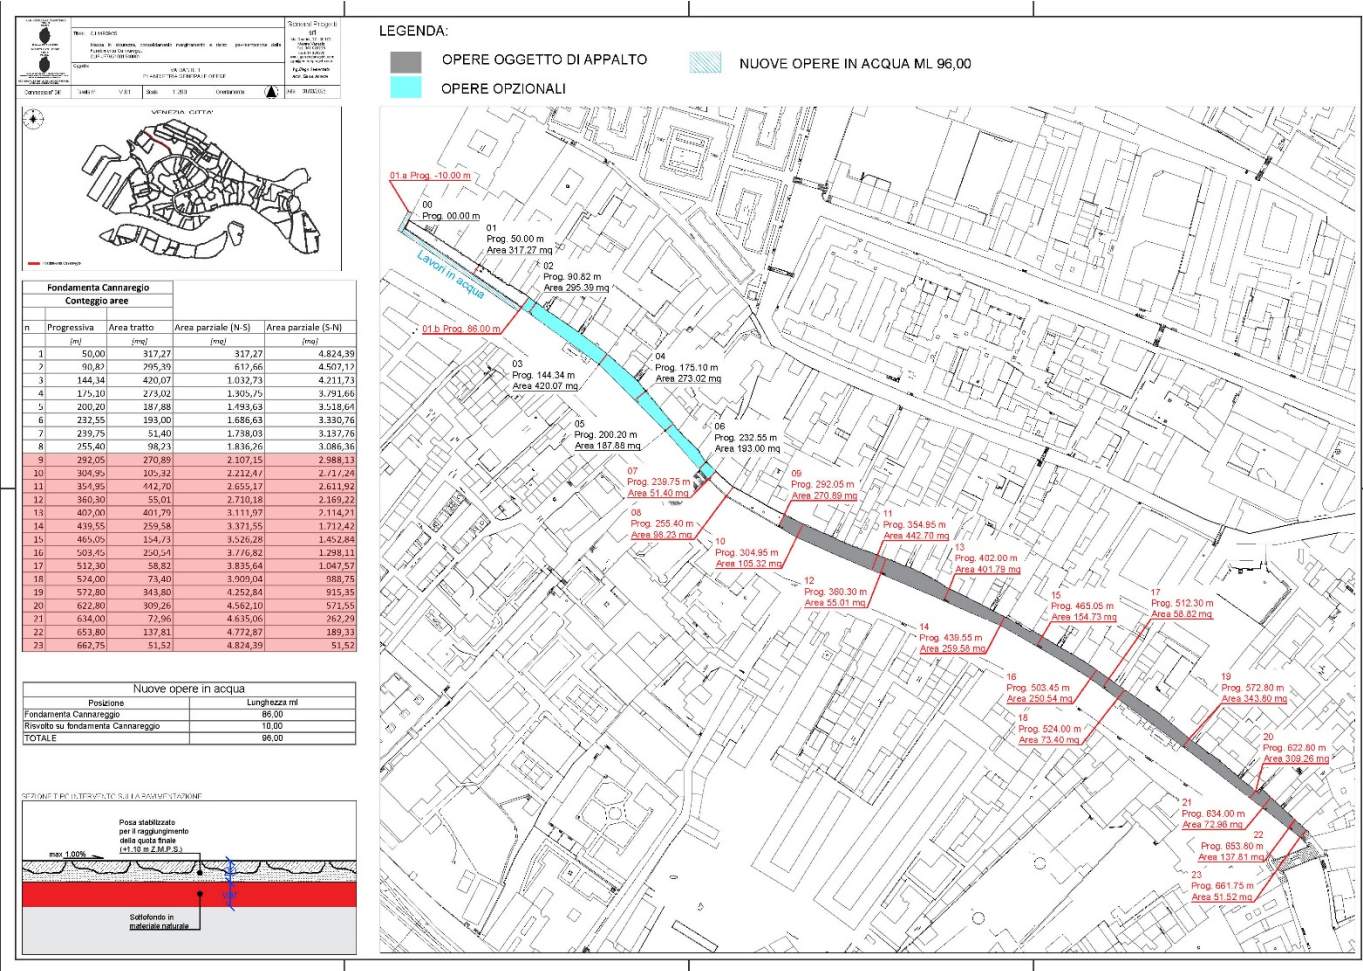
Planimetria Opere oggetto di Appalto comprese nella variante n.1
